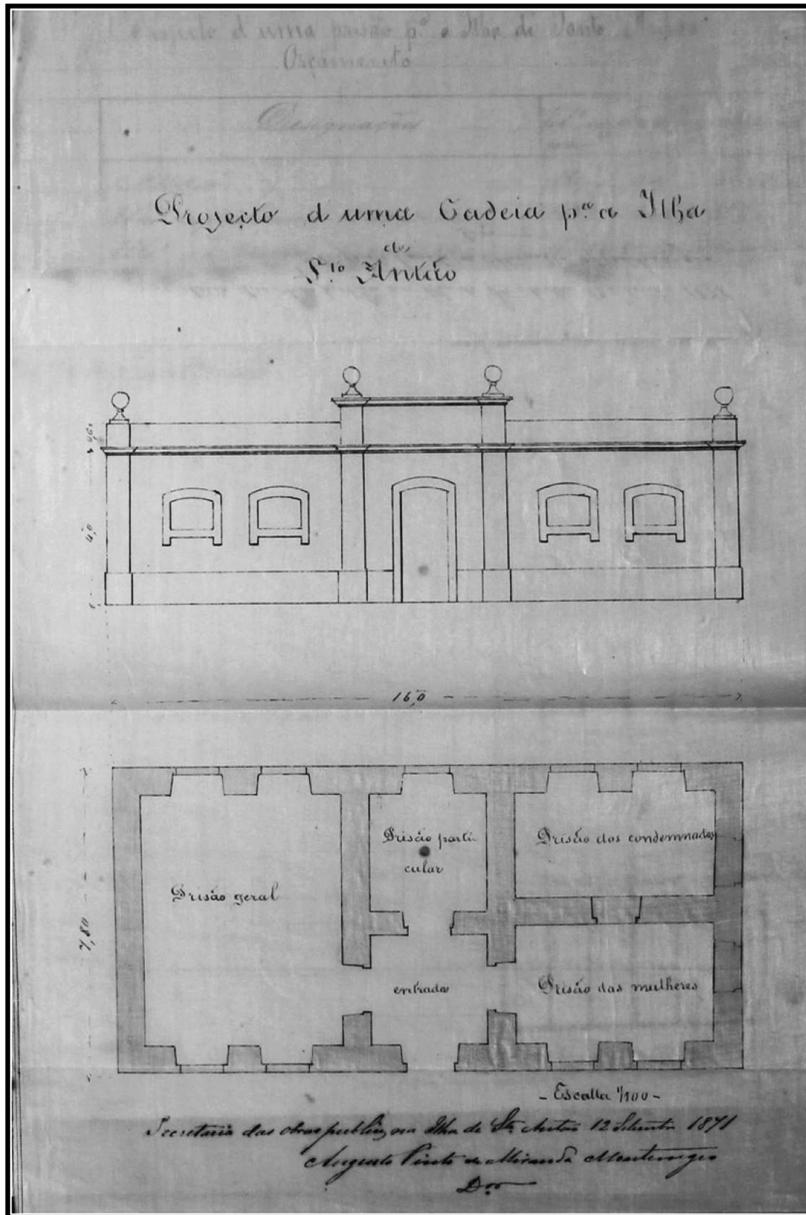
Ilha de Santo Antão. Planta e alçado do novo edifício da cadeia. Projeto do engenheiro Augusto Montenegro, Obras Públicas de Cabo Verde, 1871. AHNCV.
